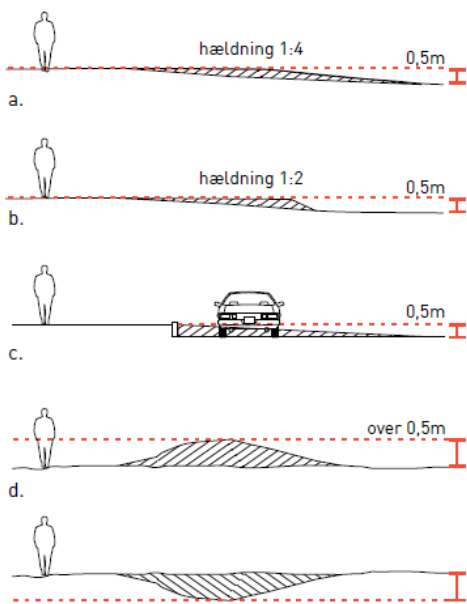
Illustrationer af forskellige typer terrænregulering. a. Bløde s-formede skrånninger med hældning på 1:4 er tilladt i grøften op til eksisterende terræn. b. Stejle skrånninger på 1:2 er tilladt. c. Støttmure er ikke tilladt. d. Terrænændringer på over + 0,5 m er ikke tilladt. e. Udgravning til regnbede, regnvandsrender og -bassiner på over - 0,5m er tilladt.
